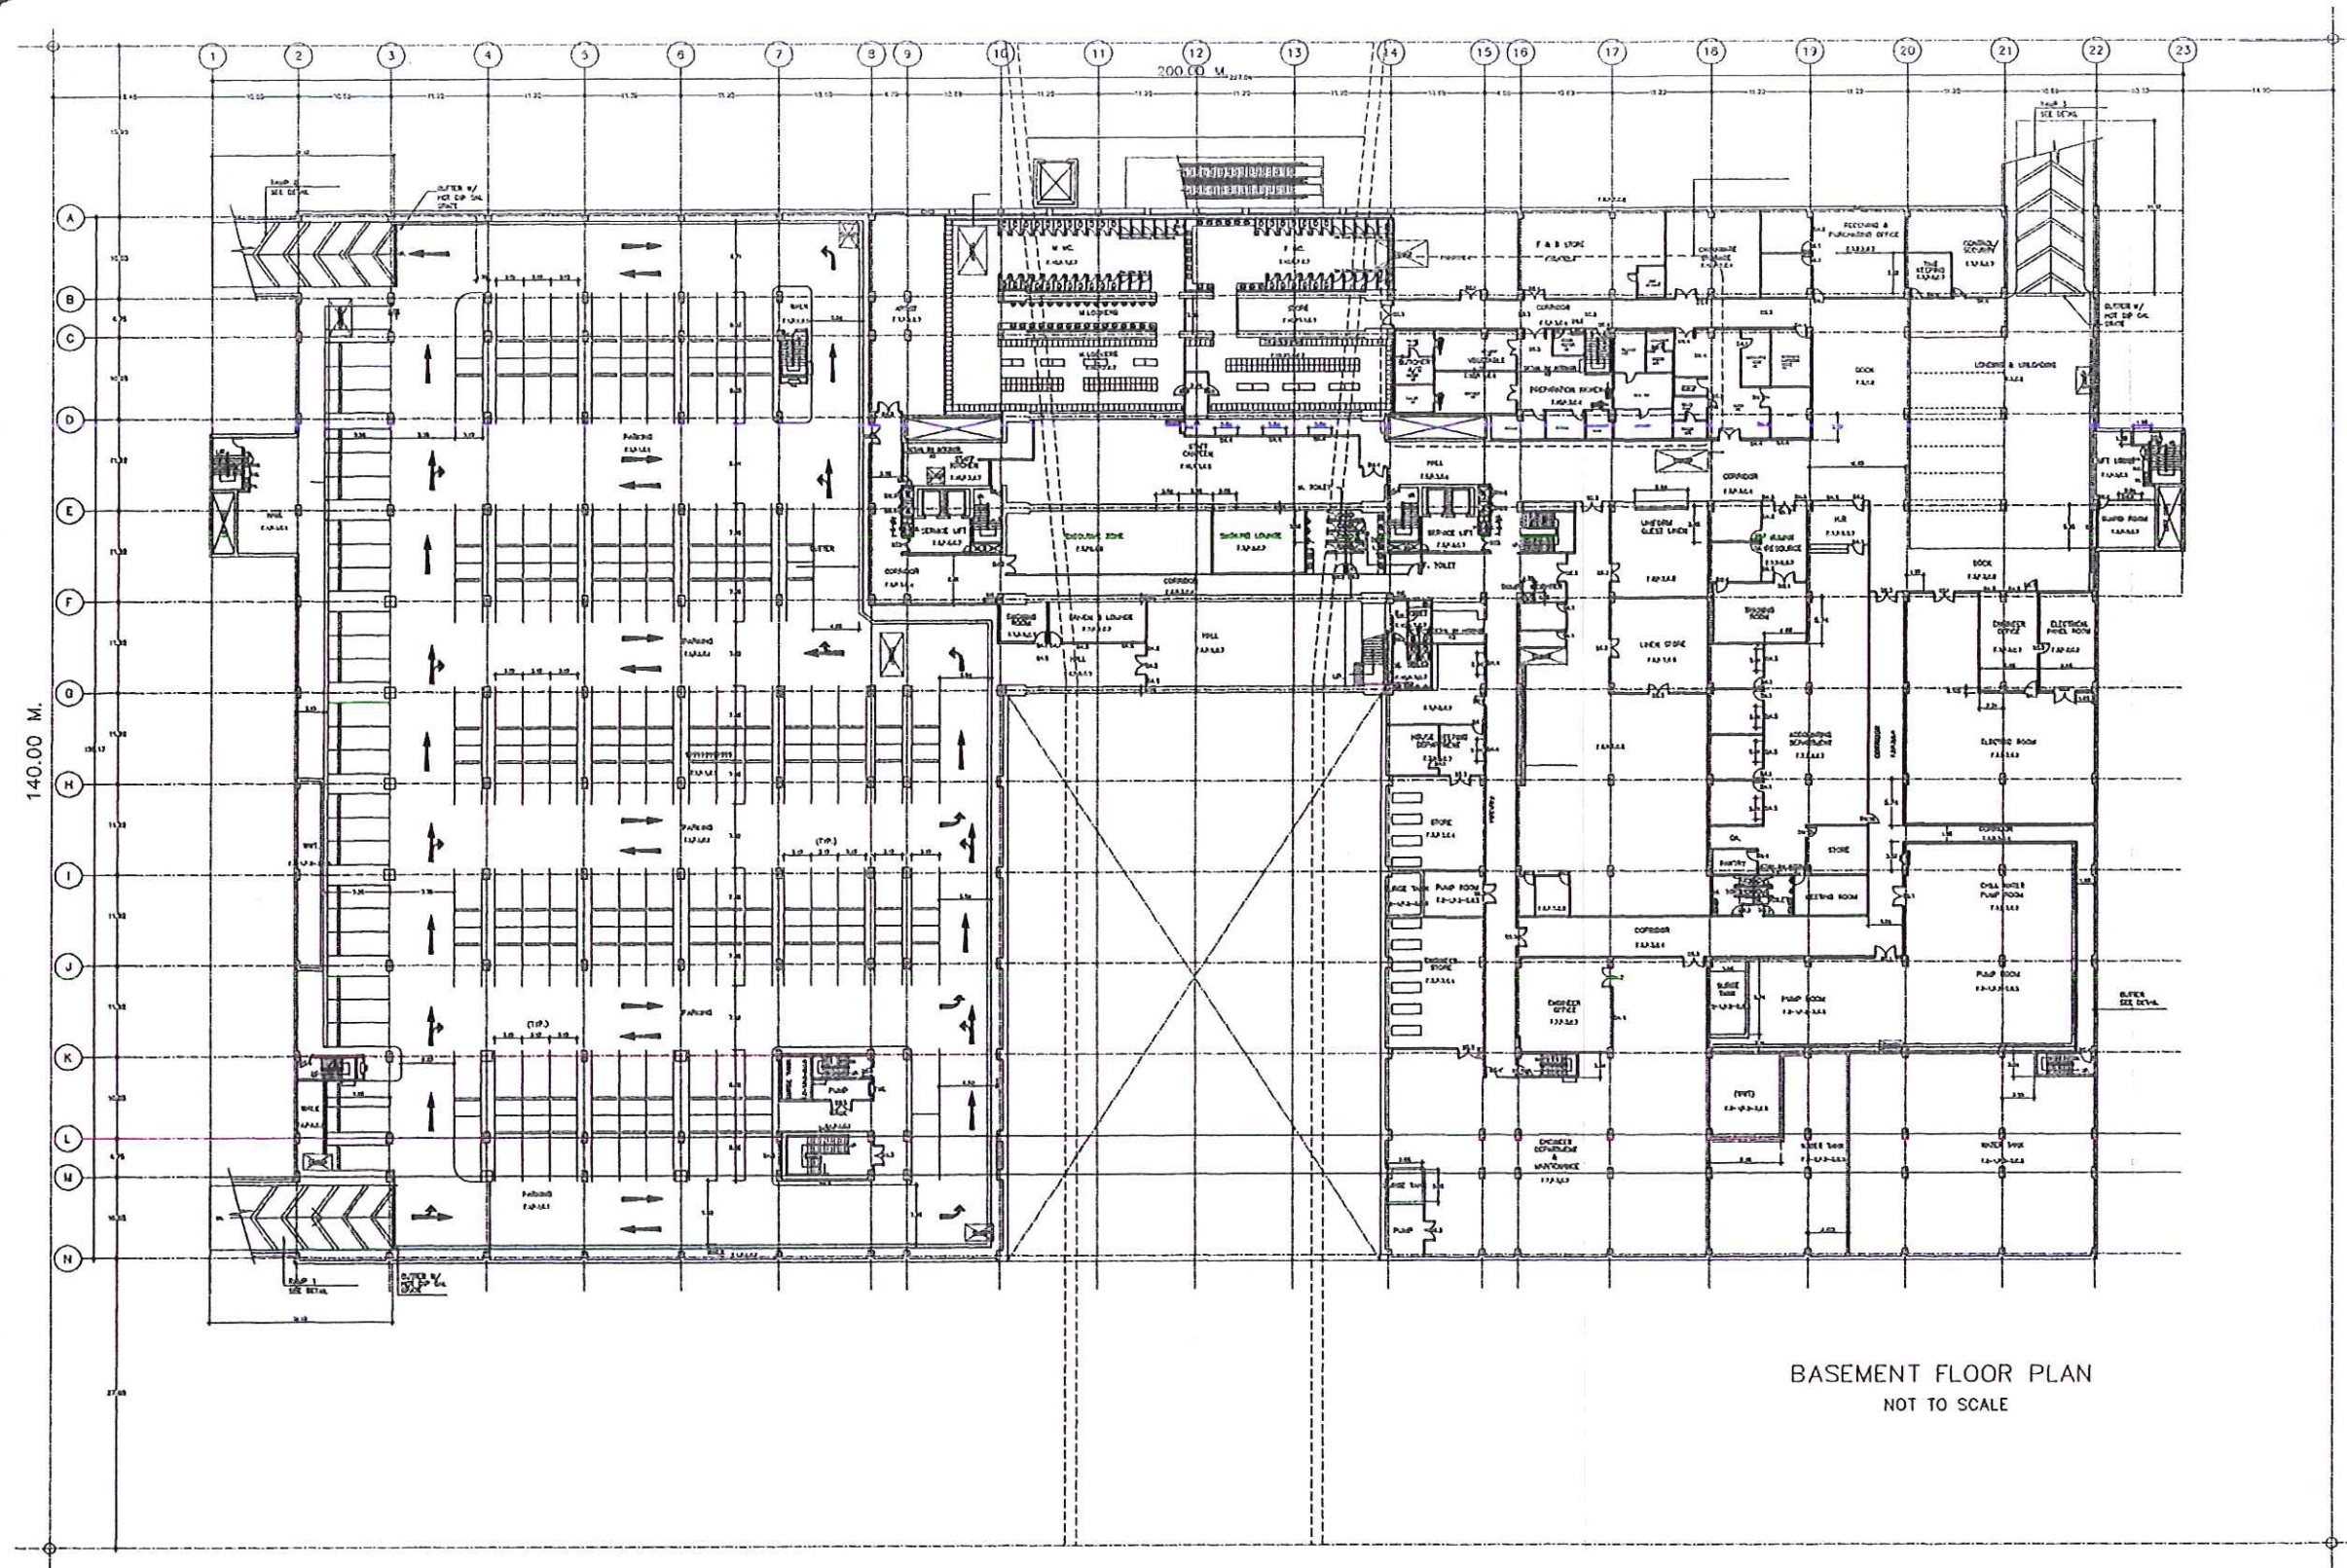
ระบบจราจรภายในพื้นที่โครงการ
